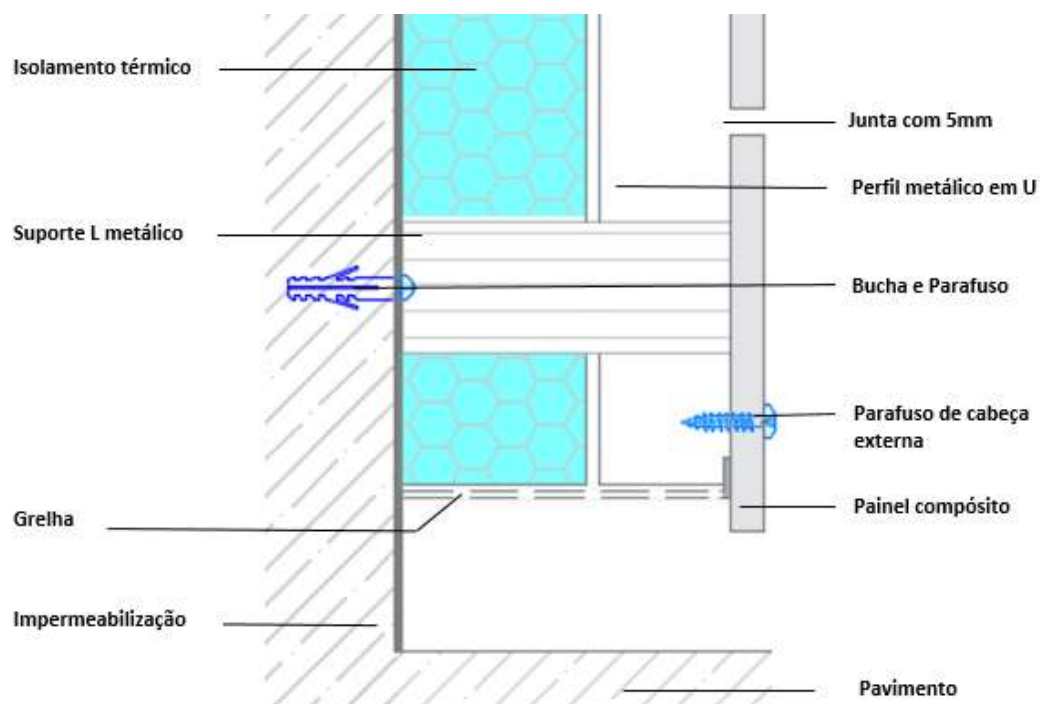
Pormenor construtivo nº2, revestimento sobre o solo.
